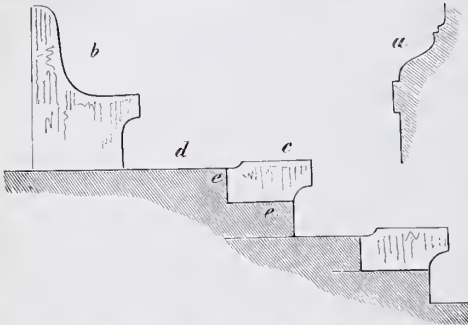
Details vom Theater zu Segeste, Aufn. von Mothes.
